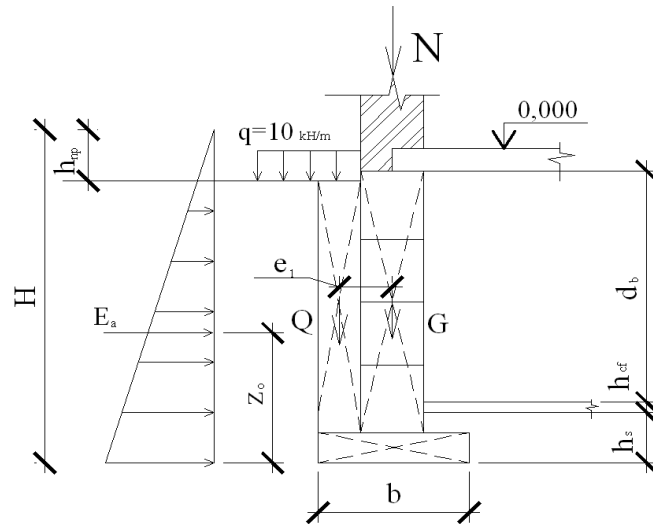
Расчетная схема внецентренно нагруженного ленточного фундамента
